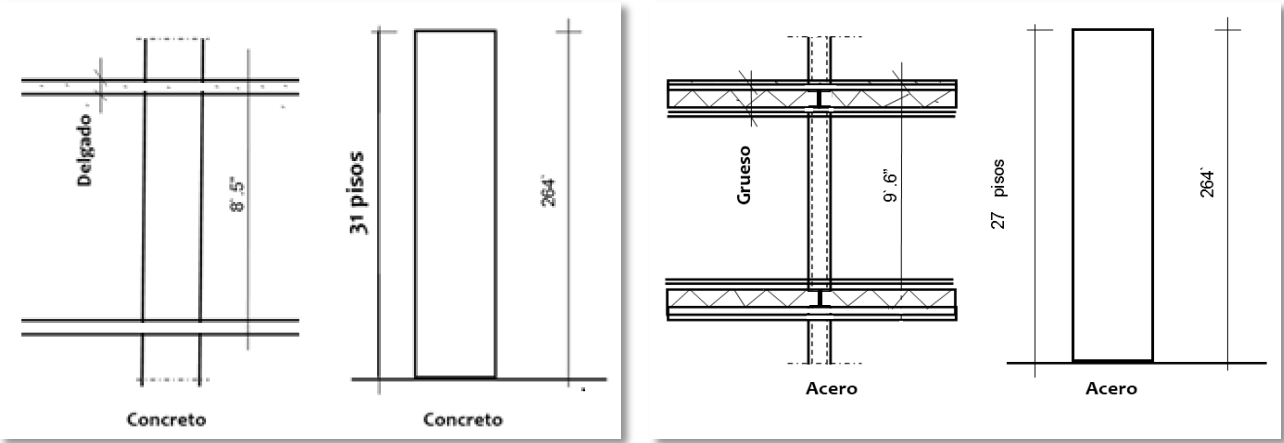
y 35. Diferencias entre estructuras de acero y concreto.
